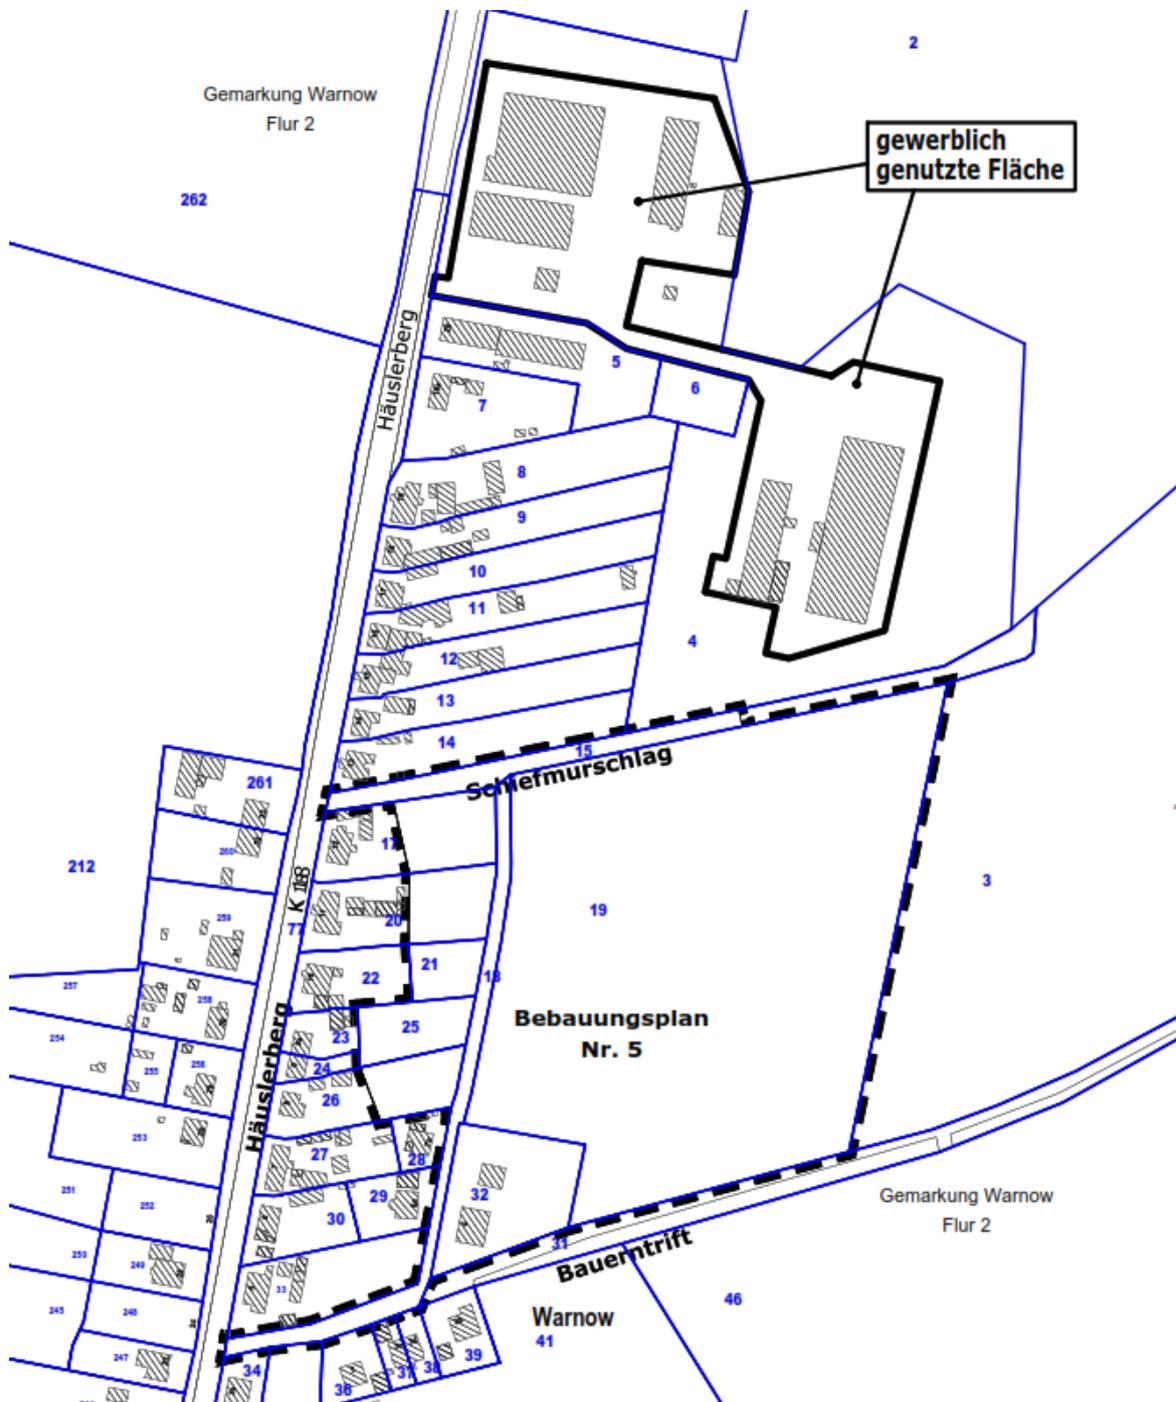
Gewerblich genutzte Flächen gemäß VE-Plan, bestehende Bebauung und Geltungsbereich B-Plan Nr. 5 (Darstellung nach [09])
